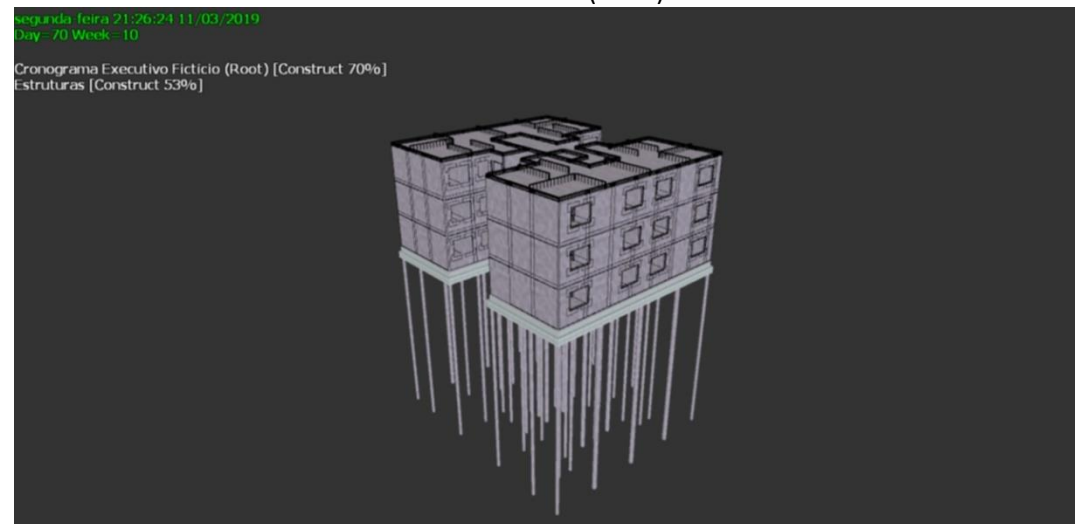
Estruturas executadas até a laje do 2º pavimento.
